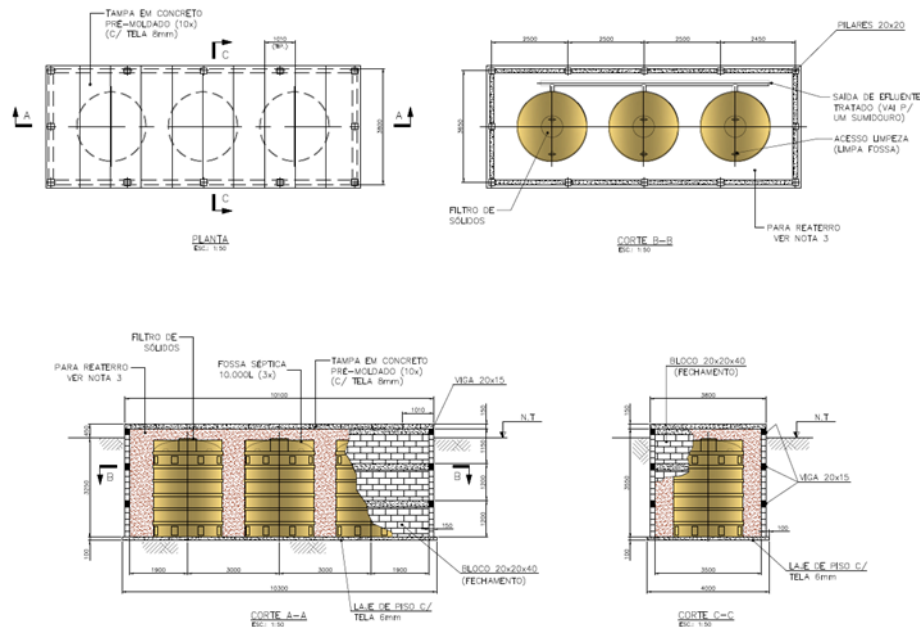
Detalhes em planta e cortes – Fossa Filtro
